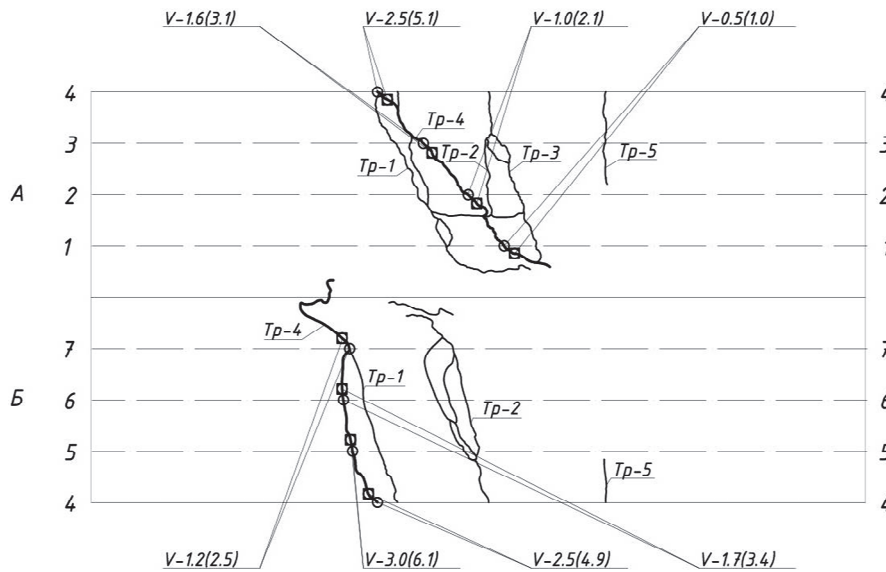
Раскрытие трещин в экспериментальной железобетонной конструкции второй серии II-БВ-КР-410 (2):
